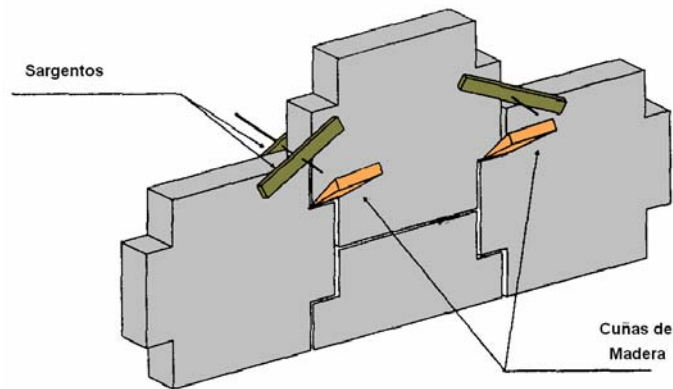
73. Esquema de la colocación de la primera hilada de placas de concreto en muro de tierra armada.
